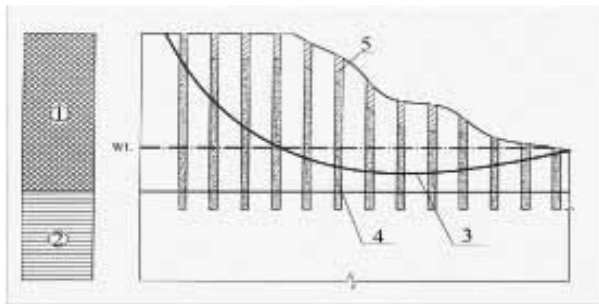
Схема армування схилу: 1 – рухливі ґрунти, 2- корінні породи; 3- поверхня ковзання; 4 – ґрунтоцементний елемент (ГЦЕ); 5- частина свердловини заповнена місцевим ґрунтом
